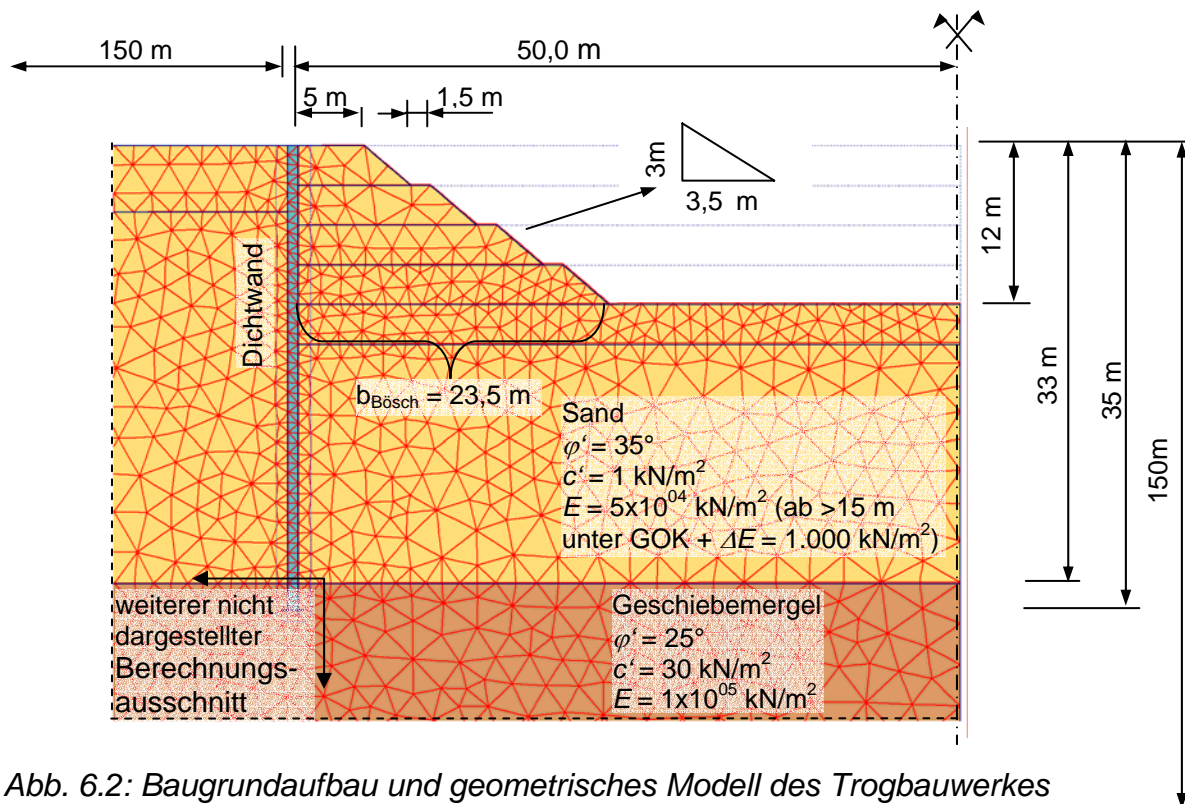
Baugrundaufbau und geometrisches Modell des Trogbauwerkes
